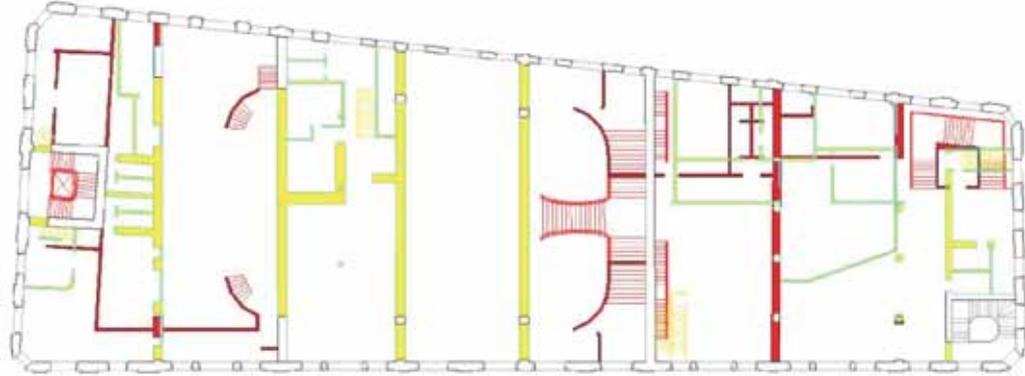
Planta de demolição e construção do pavimento térreo. Em amarelo (demolição), as paredes divisórias do imóvel e em vermelho (construção), as paredes acrescidas (Acervo pessoal Luciana Menezes, 2001).
